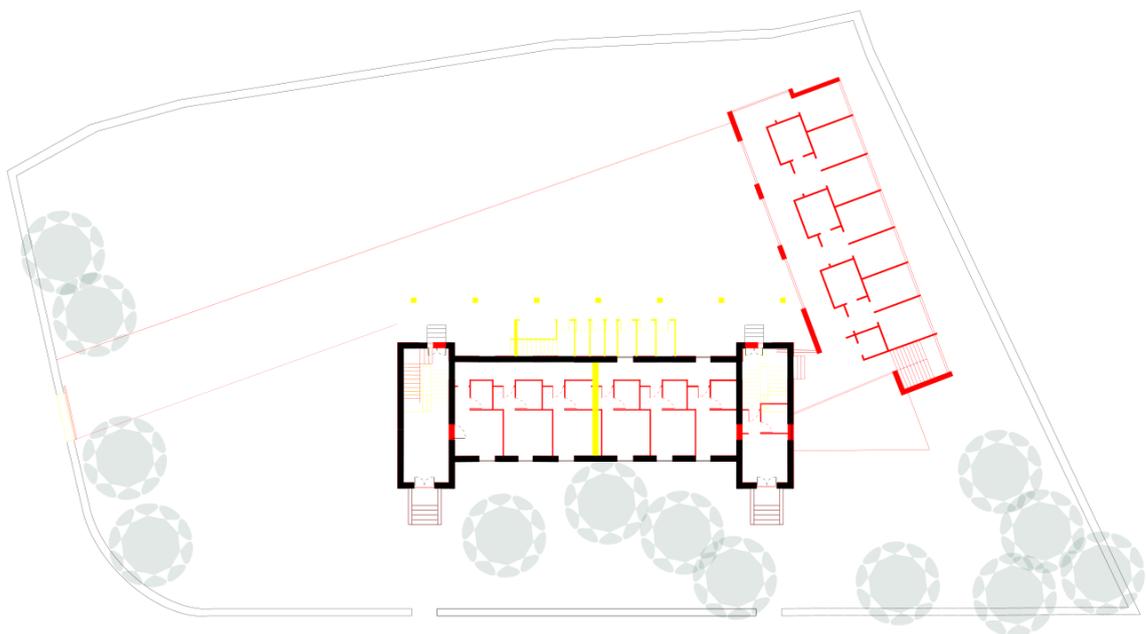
Planta de implantação do piso 1 – vermelhos e amarelos. Desenho de autor.
